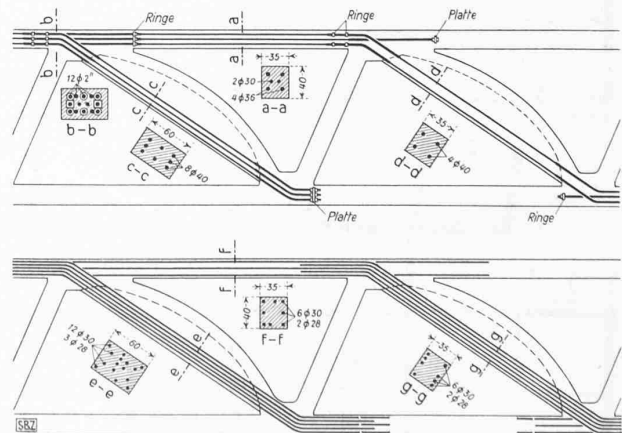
Ausschnitt aus einem Eisenbeton-Fachwerkbinder 1:150
